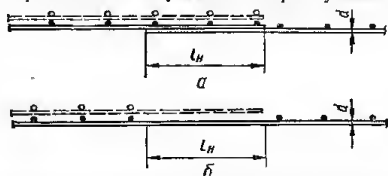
Стыки сварных сеток внахлестку (без сварки) в направлении рабочей арматуры, выполненной из стержней периодического профиля без поперечных стержней в пределах стыка:
